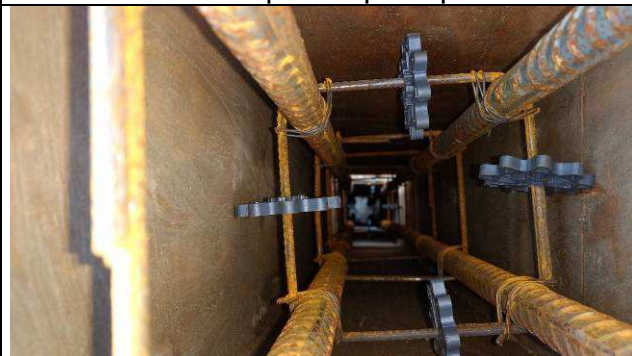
C: Formas e armaduras do pilar P13 do prédio principal.
